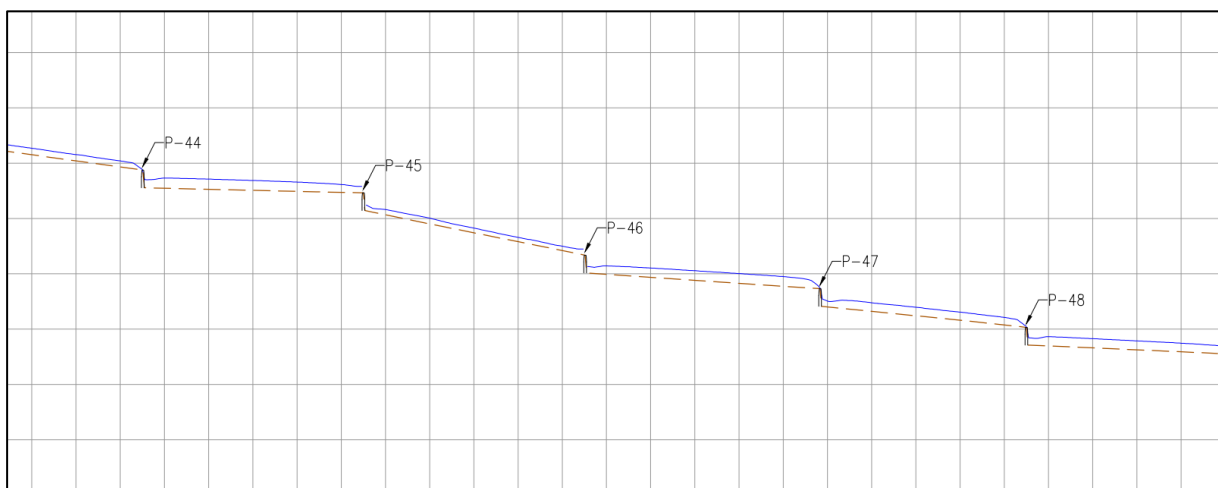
Sección transversal con muros transversales con altura 0,80 m – Avenida ordinaria
